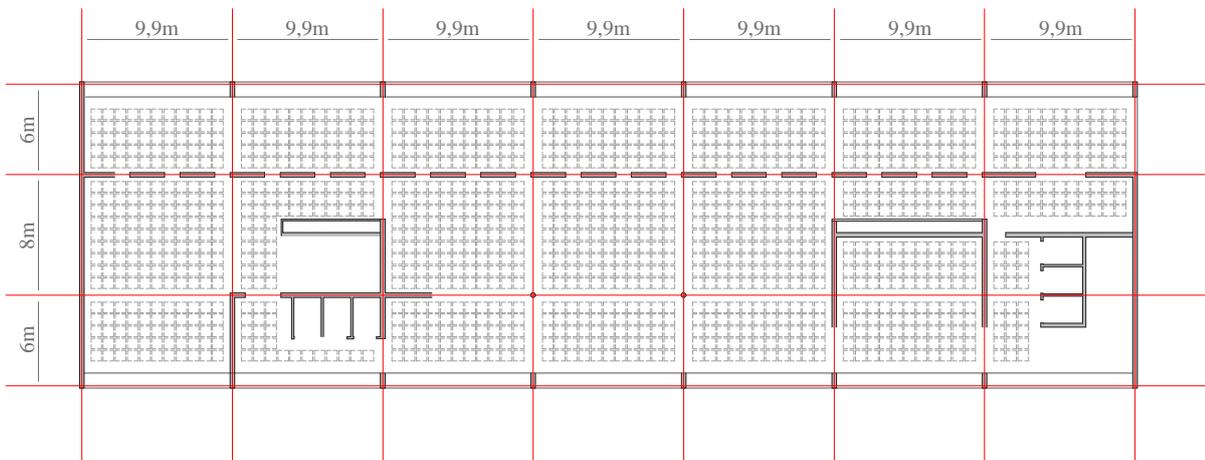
Planta tipo do edifício novo - métrica estrutural. Esc. 1/500
